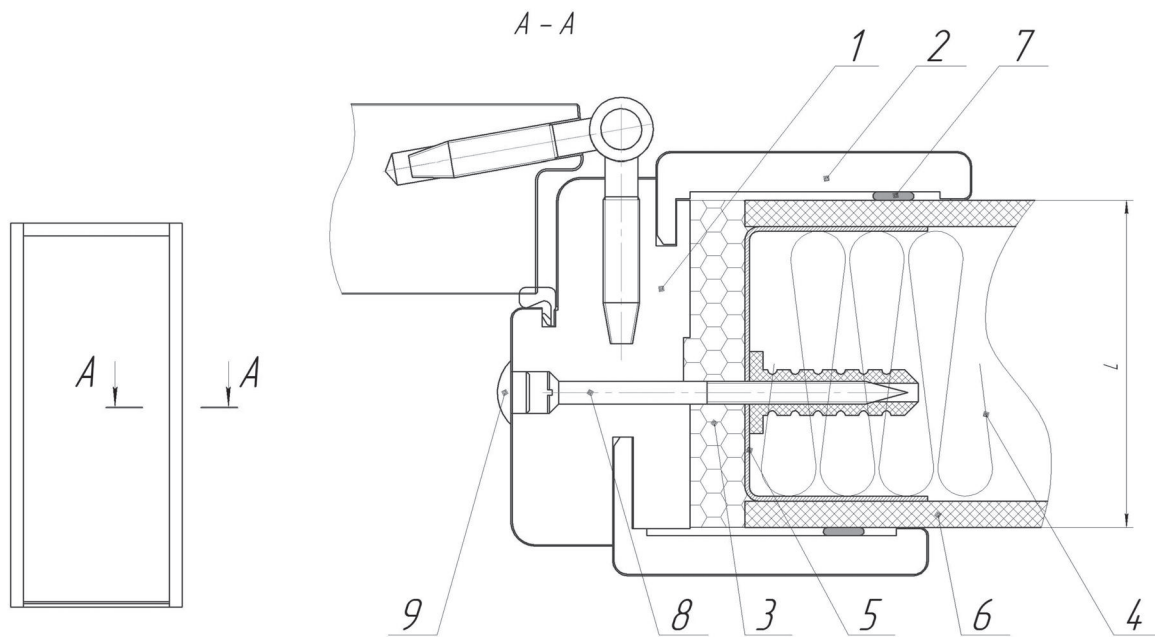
Узел примыкания дверного блока к проему однослойной стены (бетон, кирпич)
